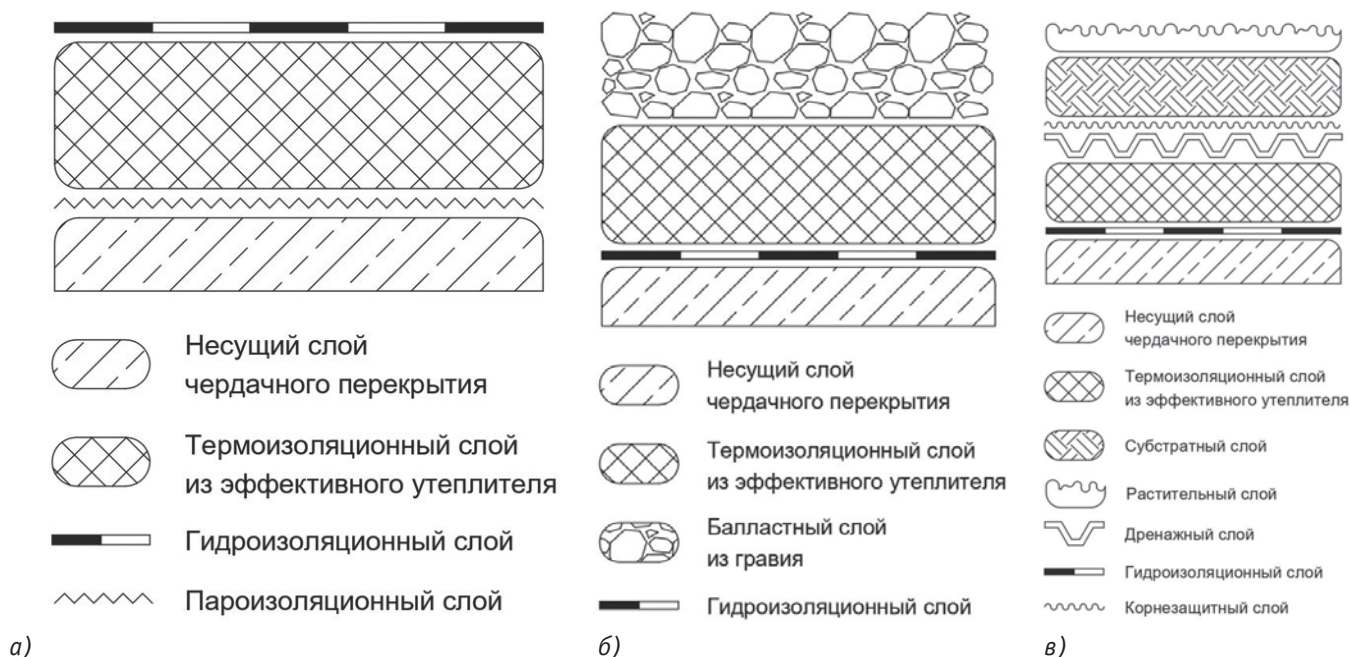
Схема расположения основных слоёв кровельного пирога (источник: [2]): а) стандартной кровли; б) инверсионной кровли; в) озелененной кровли
